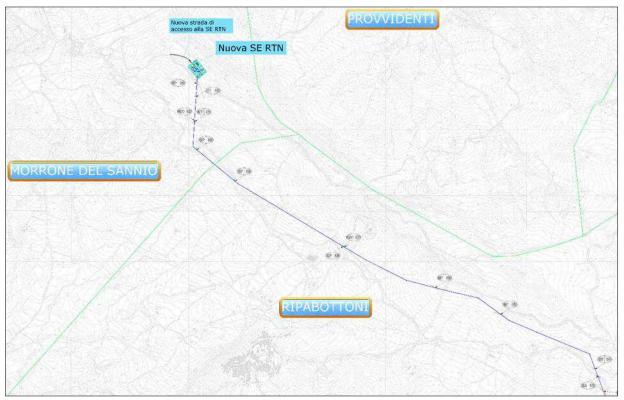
Stralcio planimetria tracciato elettrodotto su CTR (5/5)
